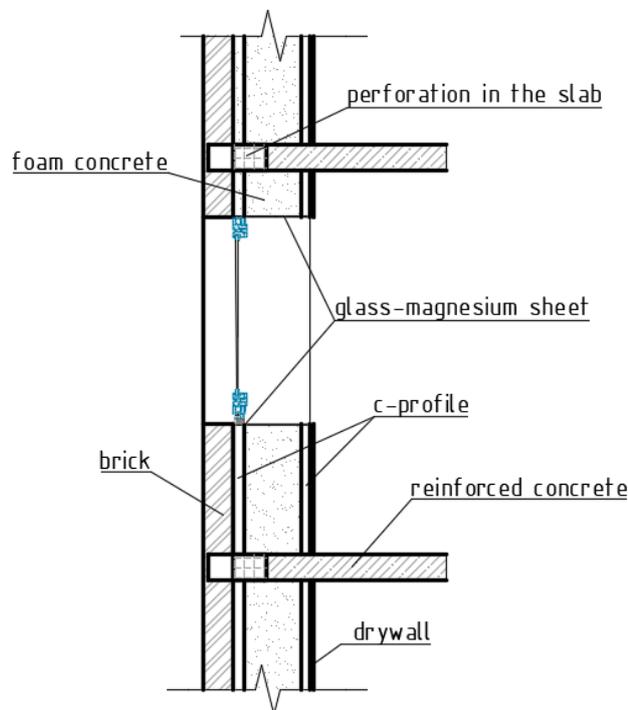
Конструкция наружной стены с кирпичной облицовкой
